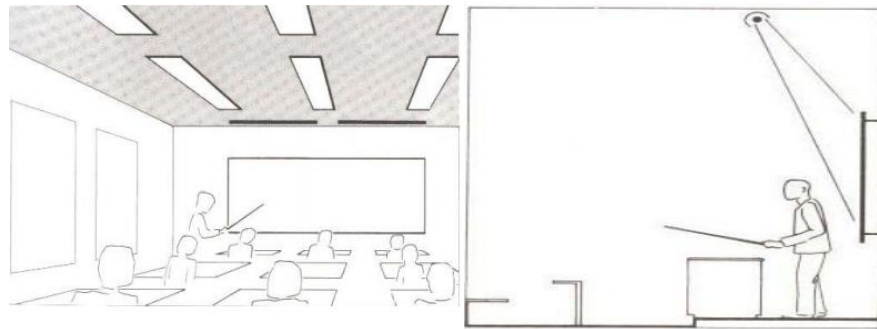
Alumbrado adicional sobre el tablero sección 420.12.2 b de RETILAP.
